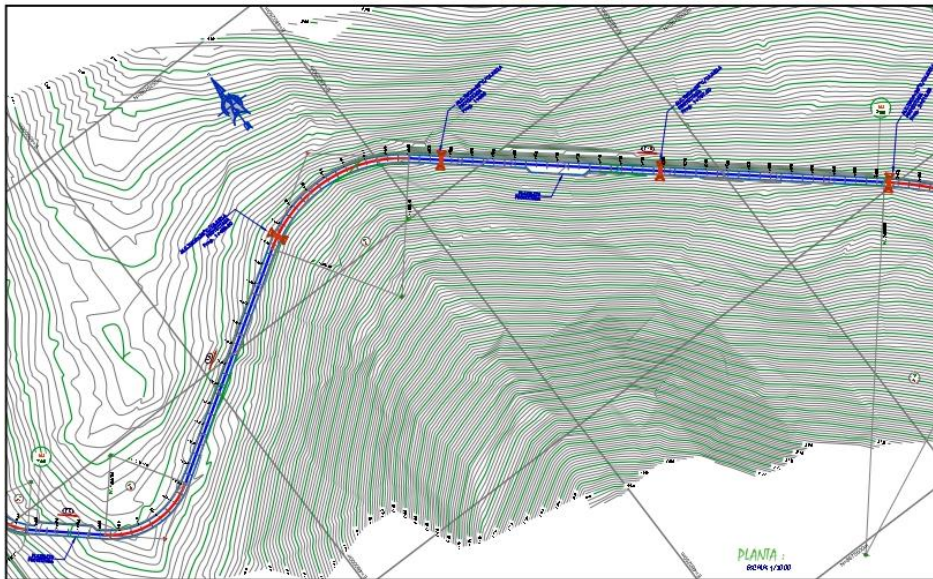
Planta Topográfica y Perfil Longitudinal- GENERAL
